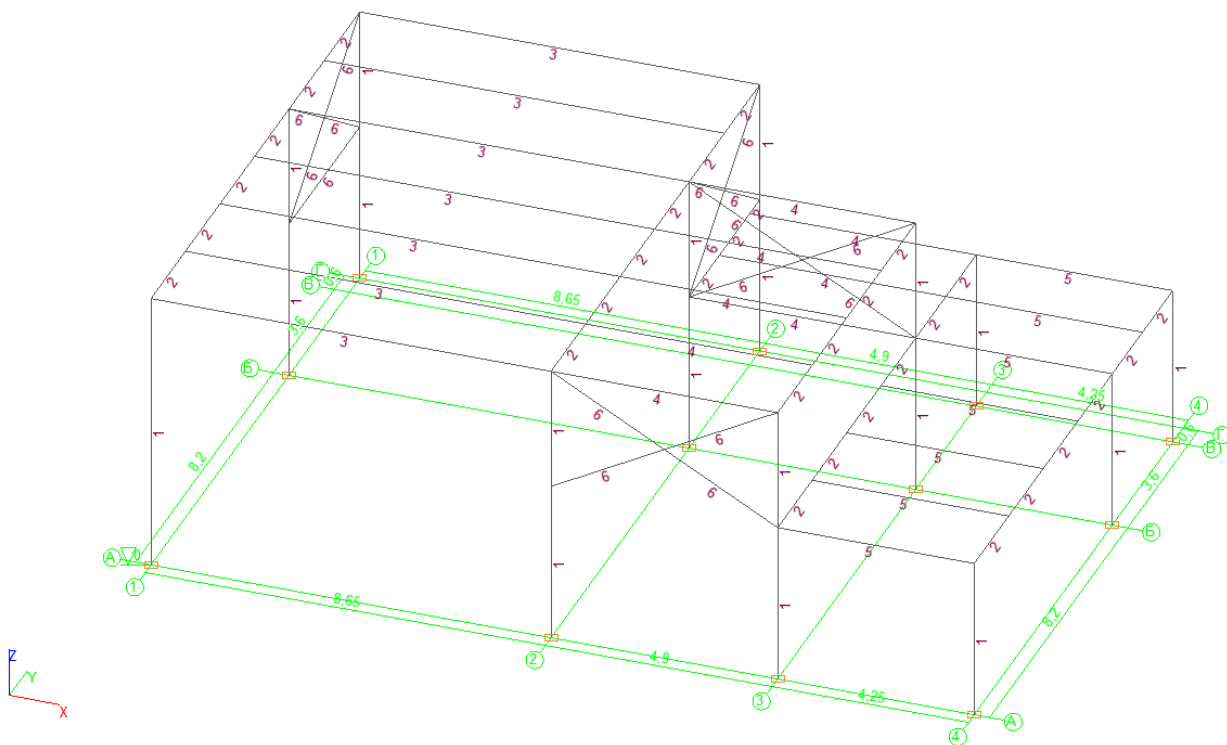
Расчётная схема стального каркаса здания в осях 1-4/А-Г.
